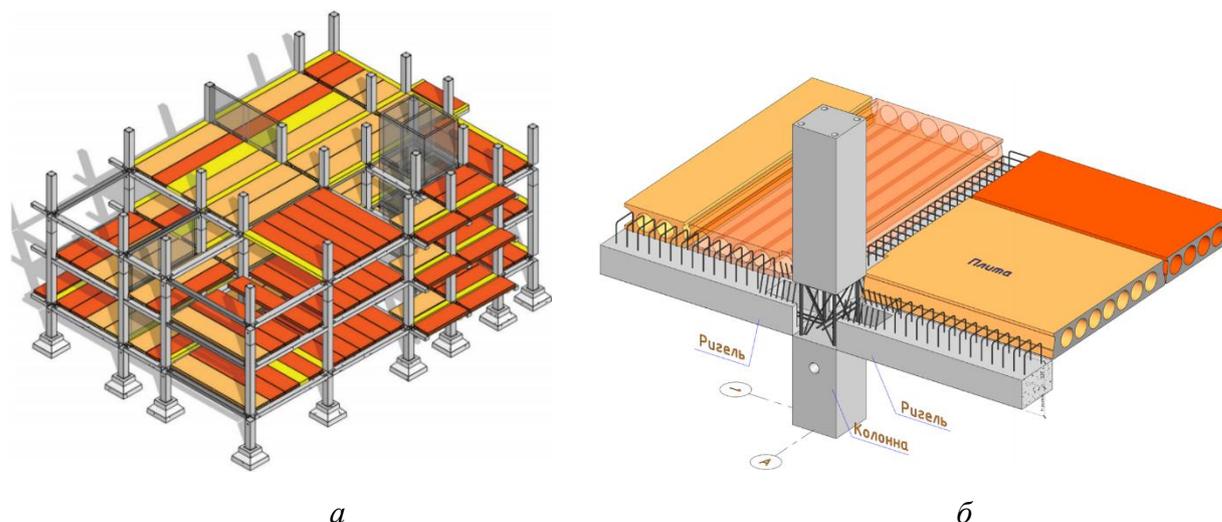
Сборно-монолитный каркас: а – общая схема сборно-монолитного каркаса; б – схема узла сборно-монолитного каркаса.
